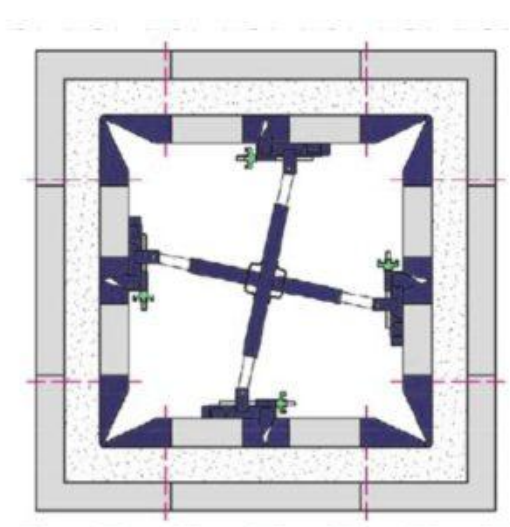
Схема работы опалубки шахт на шарнирах (рабочее положение)
